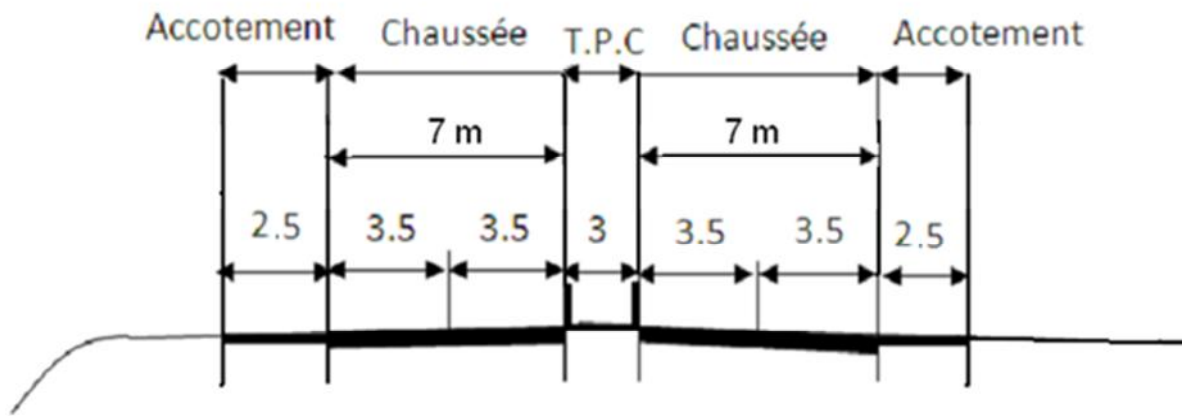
Schéma explicatif d'une Coupe transversale de la chaussée retenue
